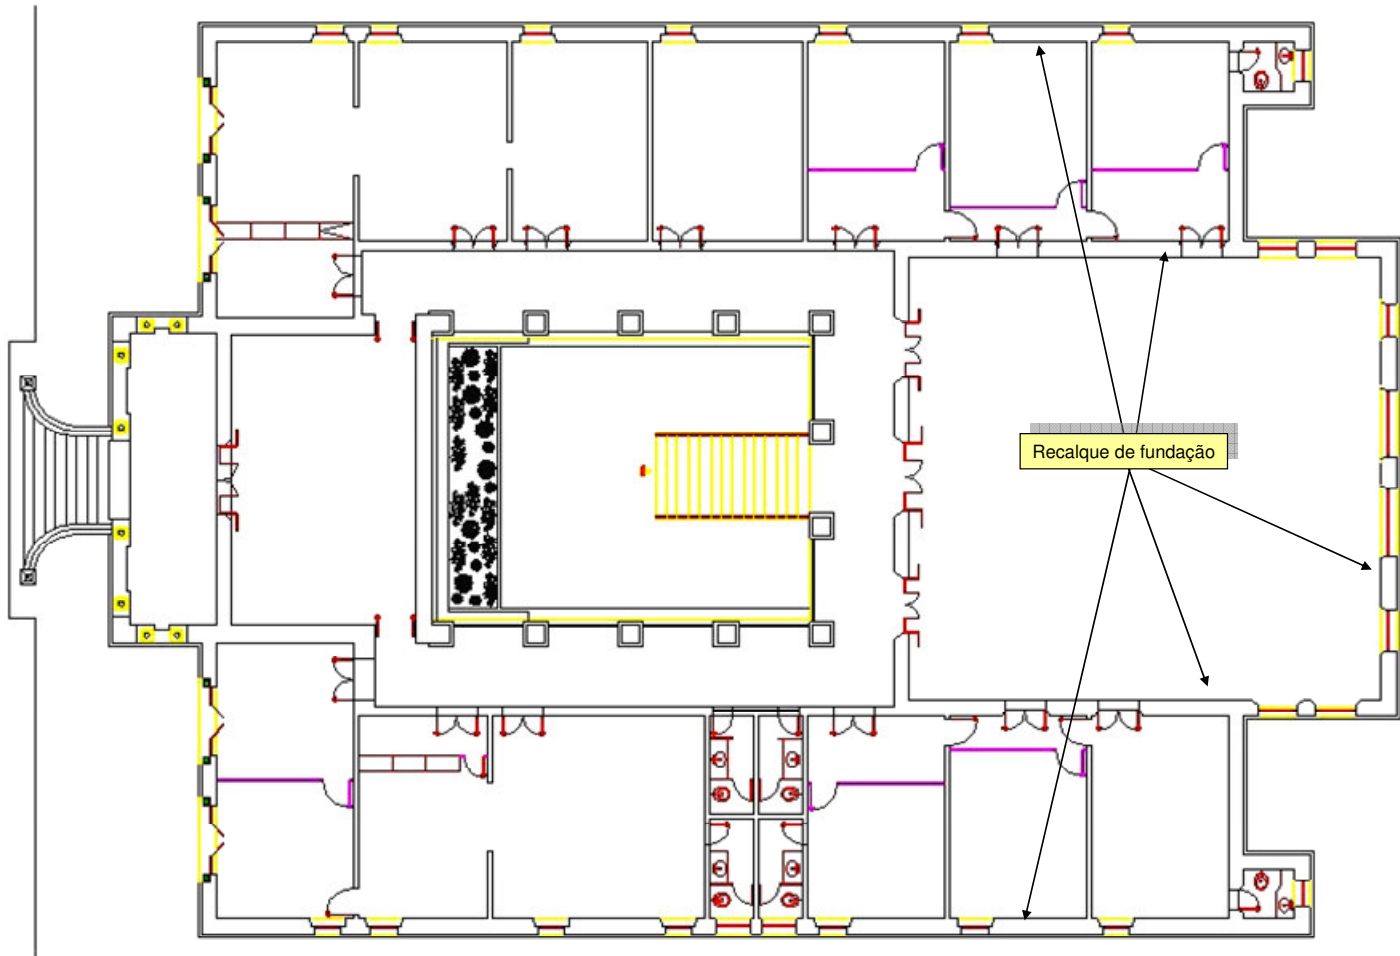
Planta do 1º pavimento e suas patologias.
